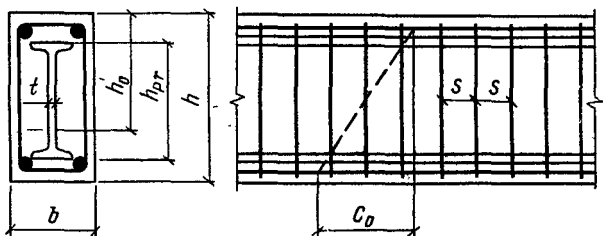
К расчету по наклонным сечениям изгибаемых элементов прямоугольного сечения, армированных жесткой арматурой
